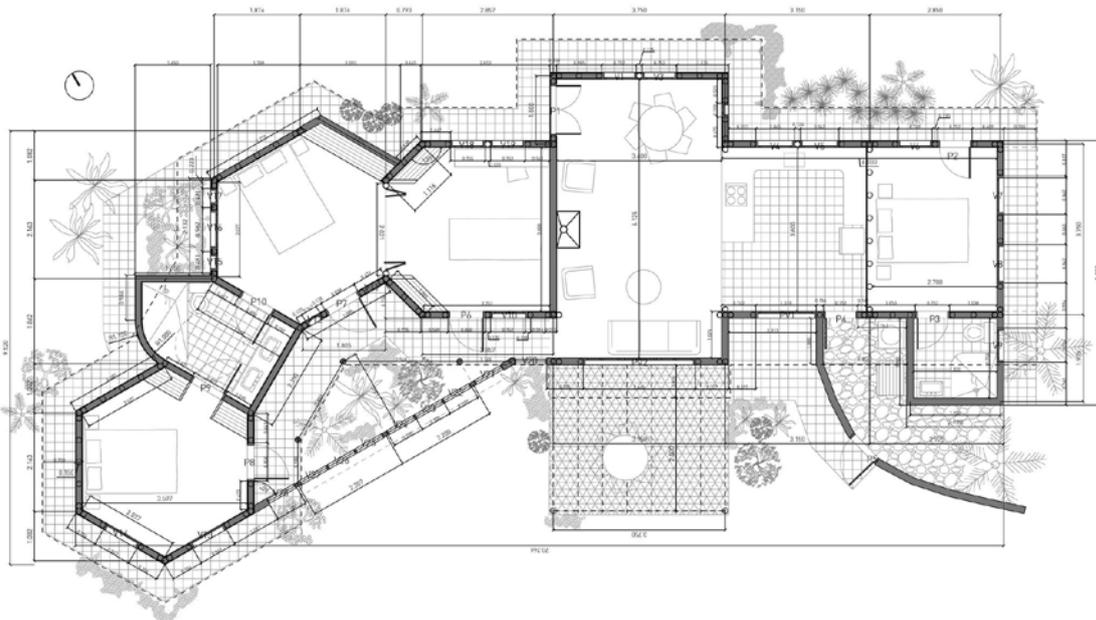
Planta arquitectónica proyecto de vivienda con técnica mixta con bahareque y domo caña (Diseño: L. Garzón)
